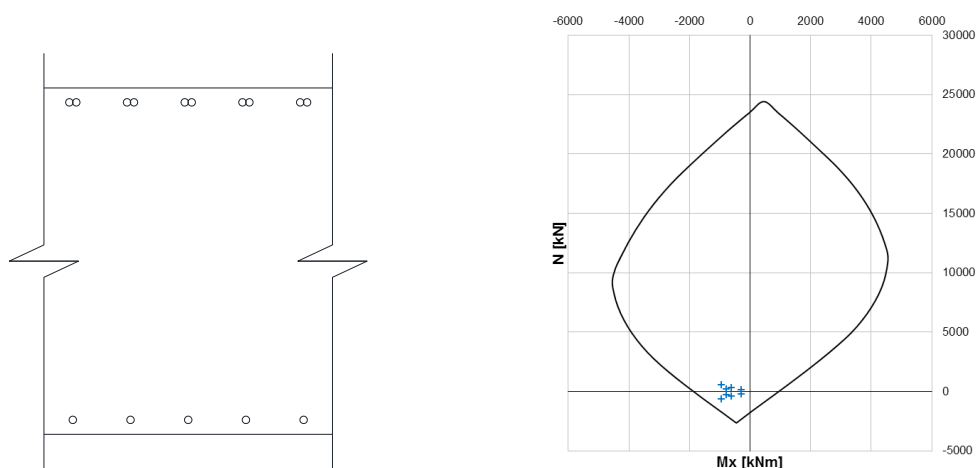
Sezione di verifica (sx), perioide SLU con sollecitazioni di verifica (dx)
